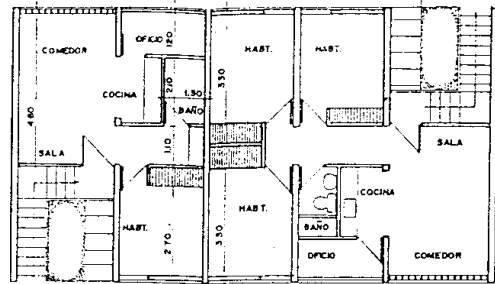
n. Bloque obrero AOD1-AOD3. Planta
